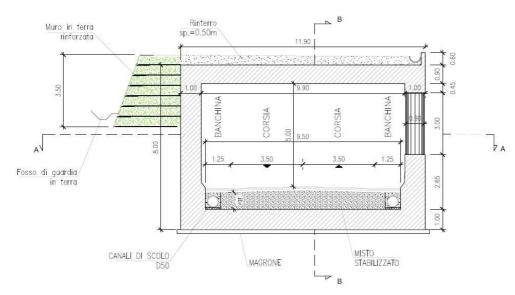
sezione trasversale tipo galleria sfinestrata da 8m
